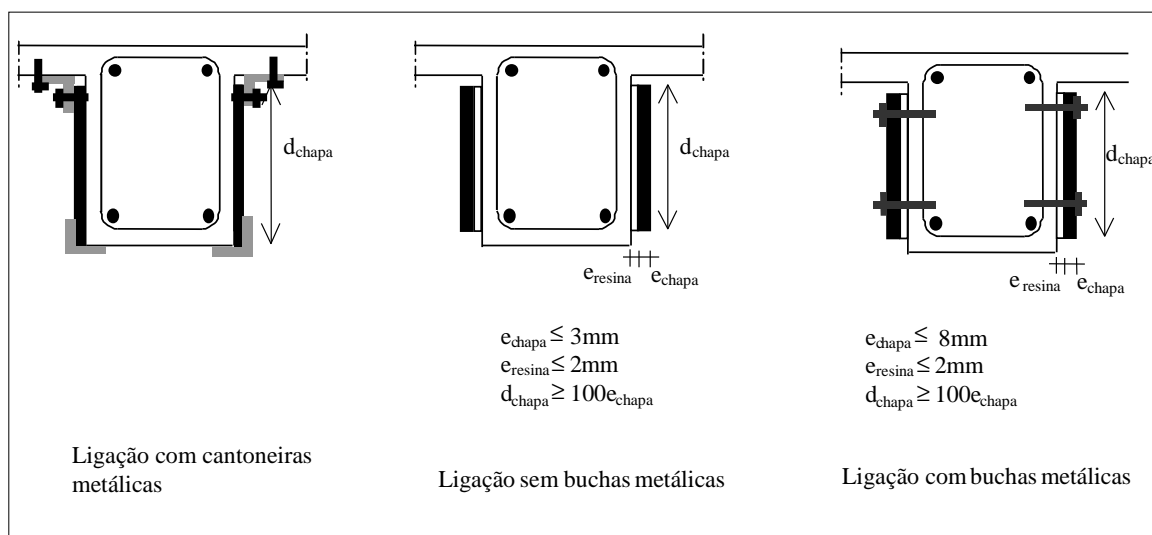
Reforço de vigas ao esforço transversal com chapas metálicas [31].
